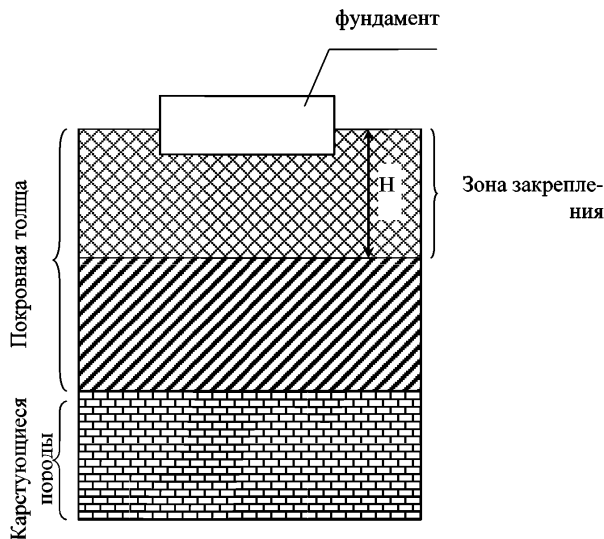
Закрепление грунтов покровной толщи под фундаментом на глубину H , определяемую расчетом
